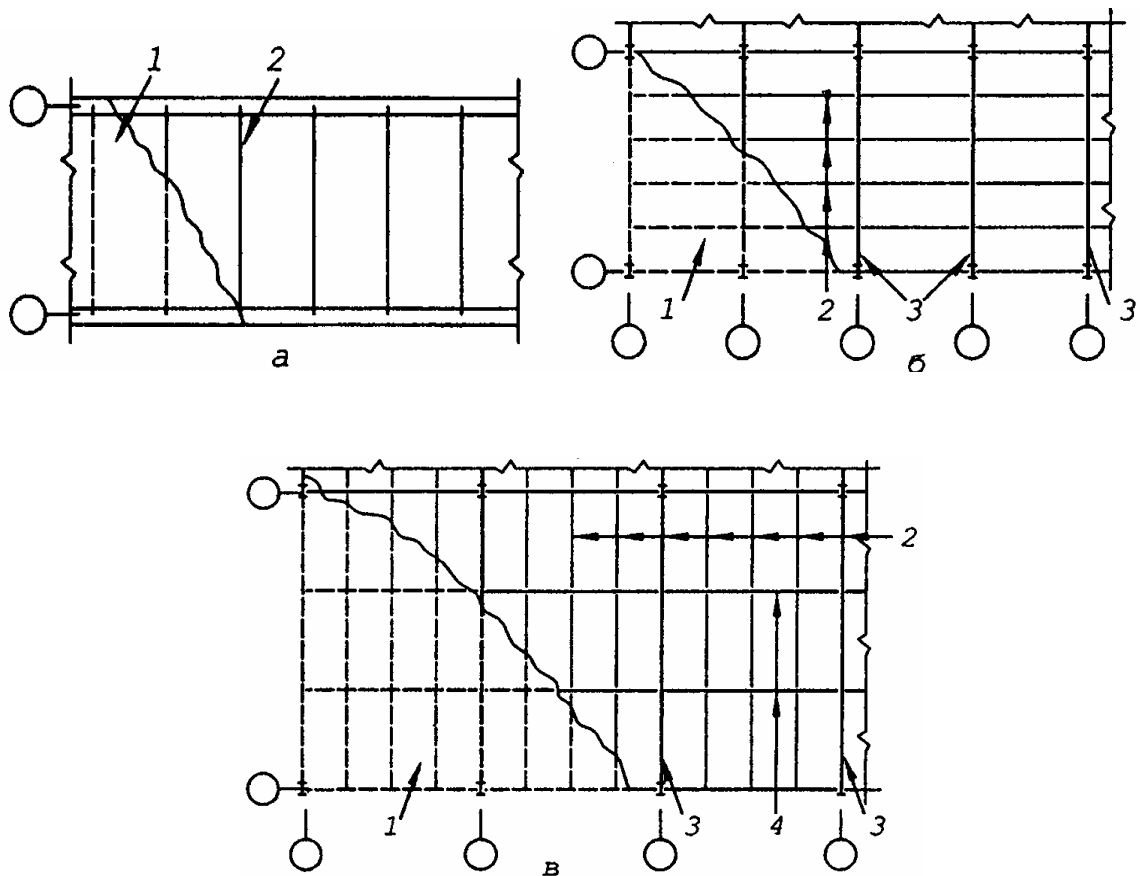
Схеми балкових кліток: а – спрощений; б – нормальний; в – ускладнений; 1 – настил; 2 – балки настилу; 3 – головні балки; 4 – допоміжні балки
